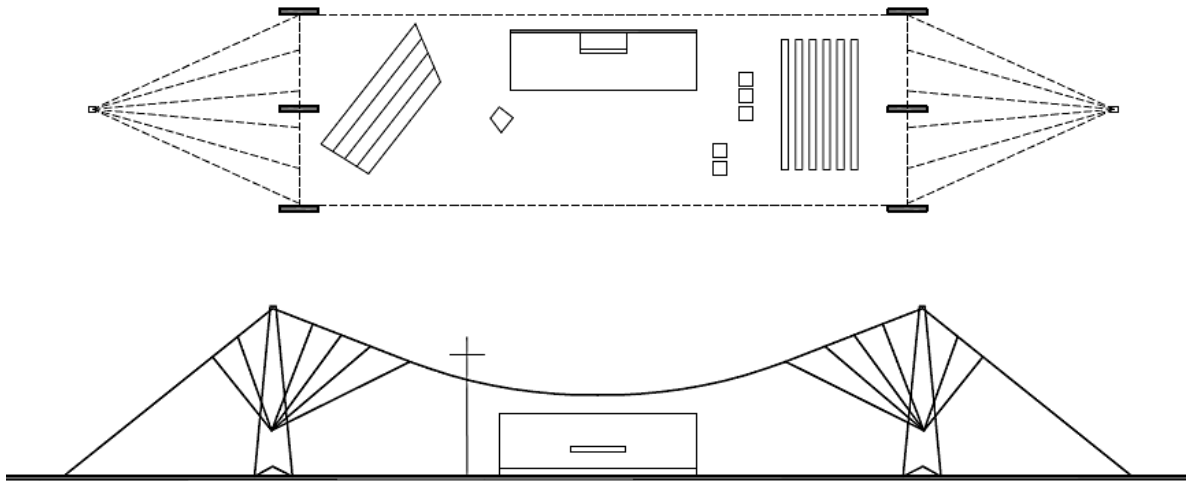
| Altar para primeira missa em Brasília. Planta baixa e elevação
